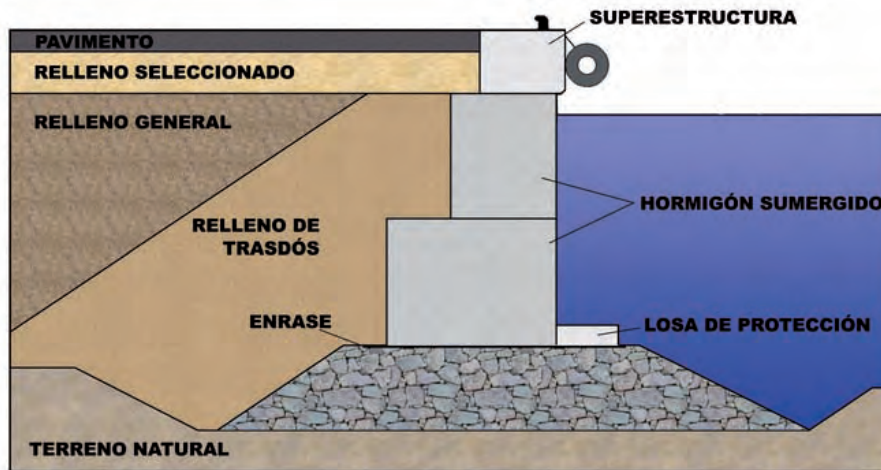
a A Sección muelle de hormigón sumergido
